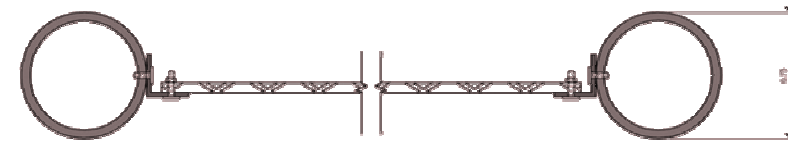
DETALLES CONSTRUCTIVOS. Fuente: Elaboración propia.
